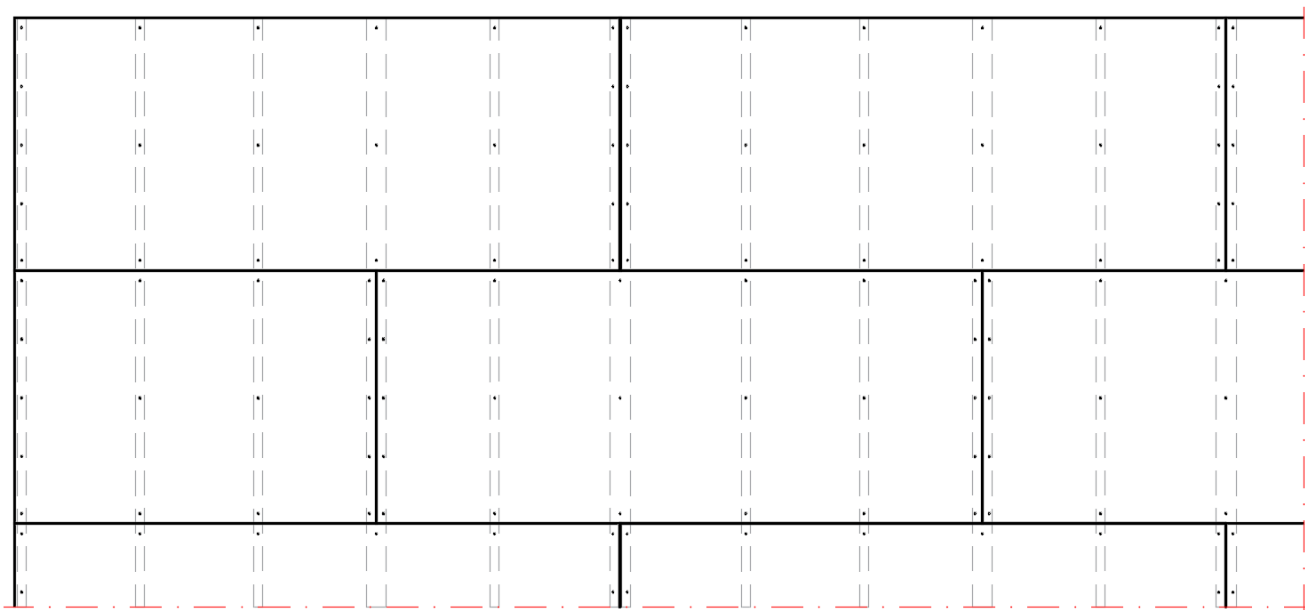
Vista geral de um pavimento apoiado sobre vigas
